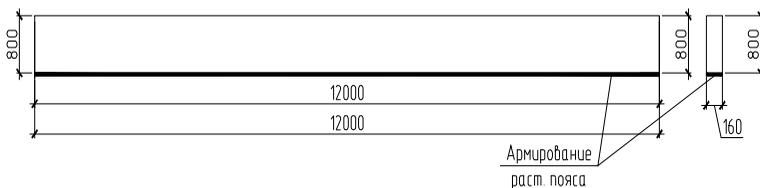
Расчетная схема балки с послойным армированием сетками растянутого пояса
